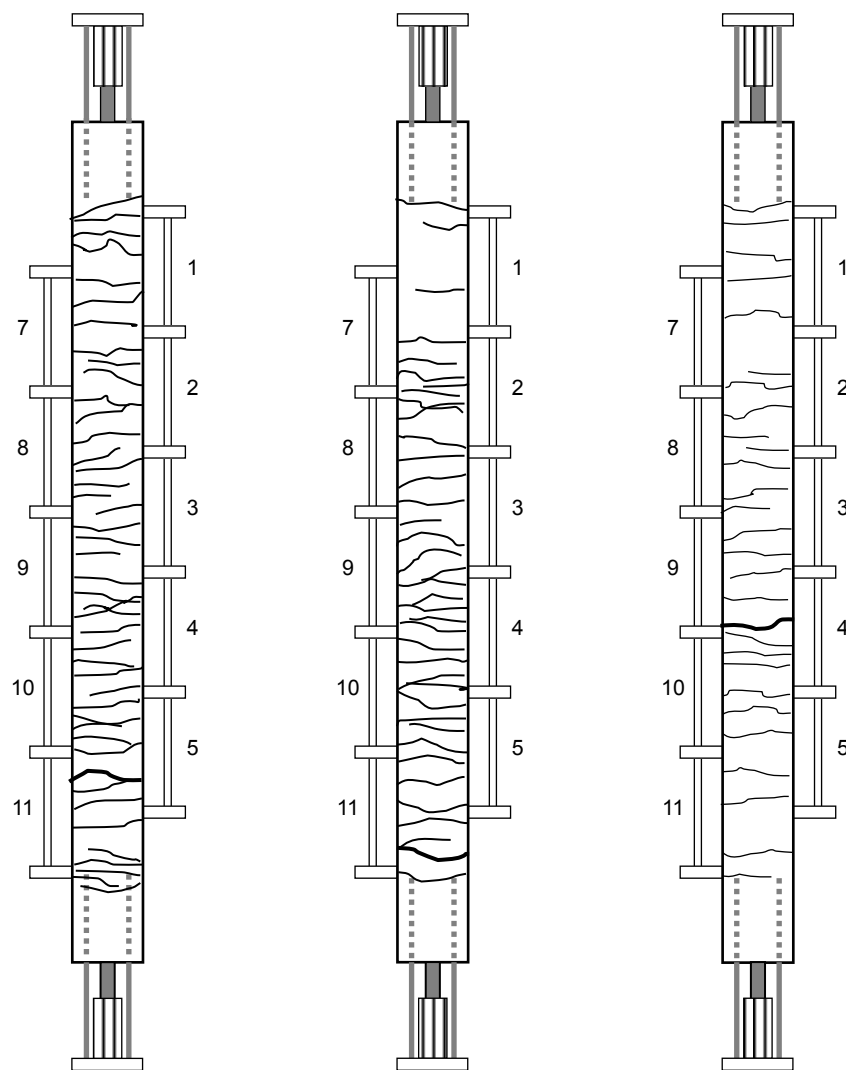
両引き試験体のひび割れ図(TS16-x(b))
